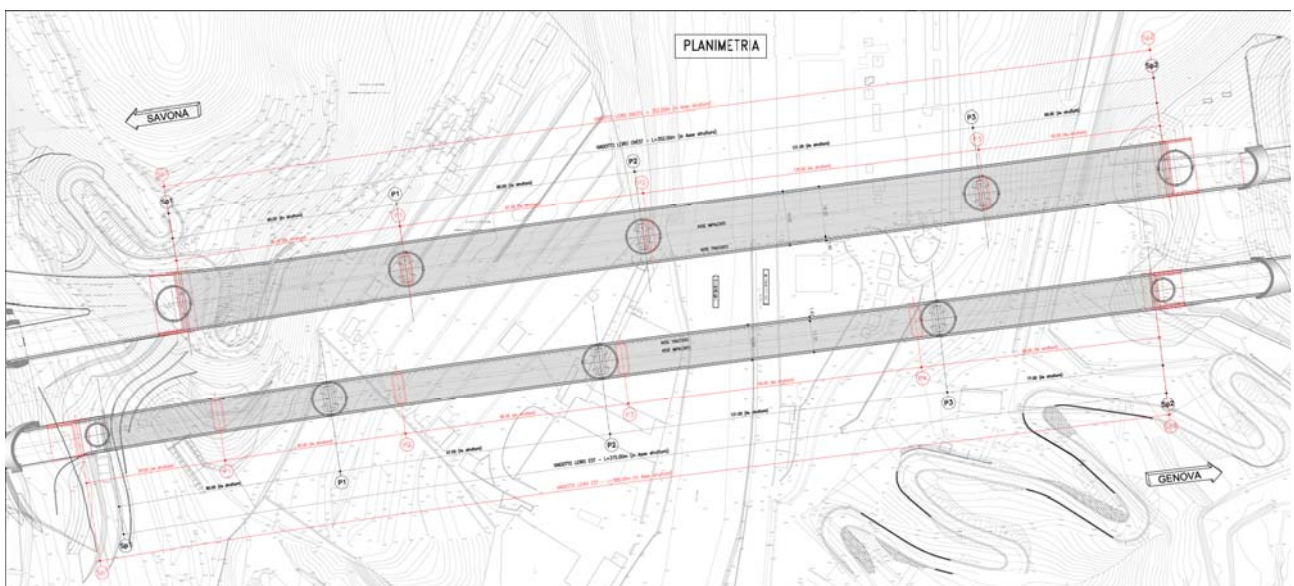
Variante progettuale: planimetria (in rosso l’ubicazione delle pile nella soluzione originale)
